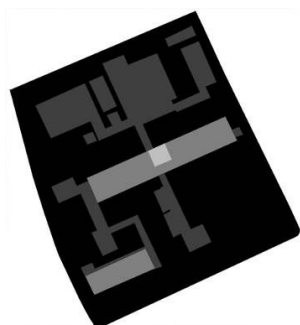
Esquema da planta de implantação da Escola Secundária Jorge Peixinho, no Montijo.
